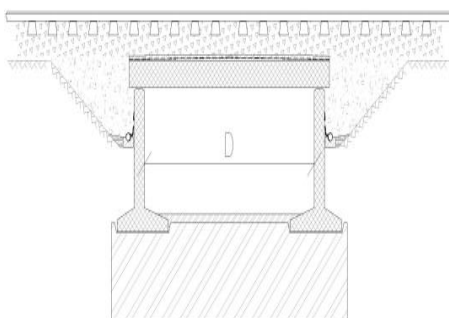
Exemplu de podeț realizat din dale prefabricate din beton armat
